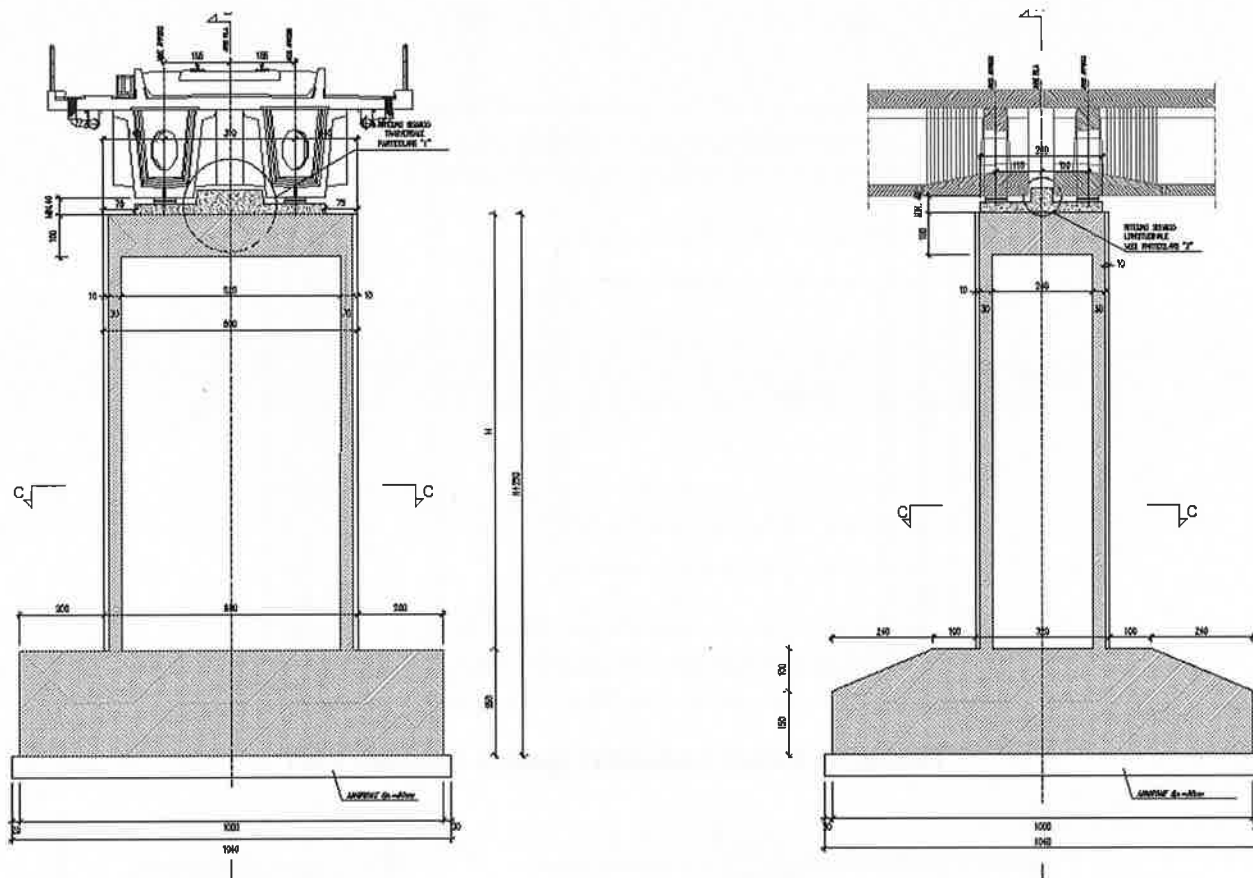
Sezioni verticali pila H> 11m, Bauladu VI02
